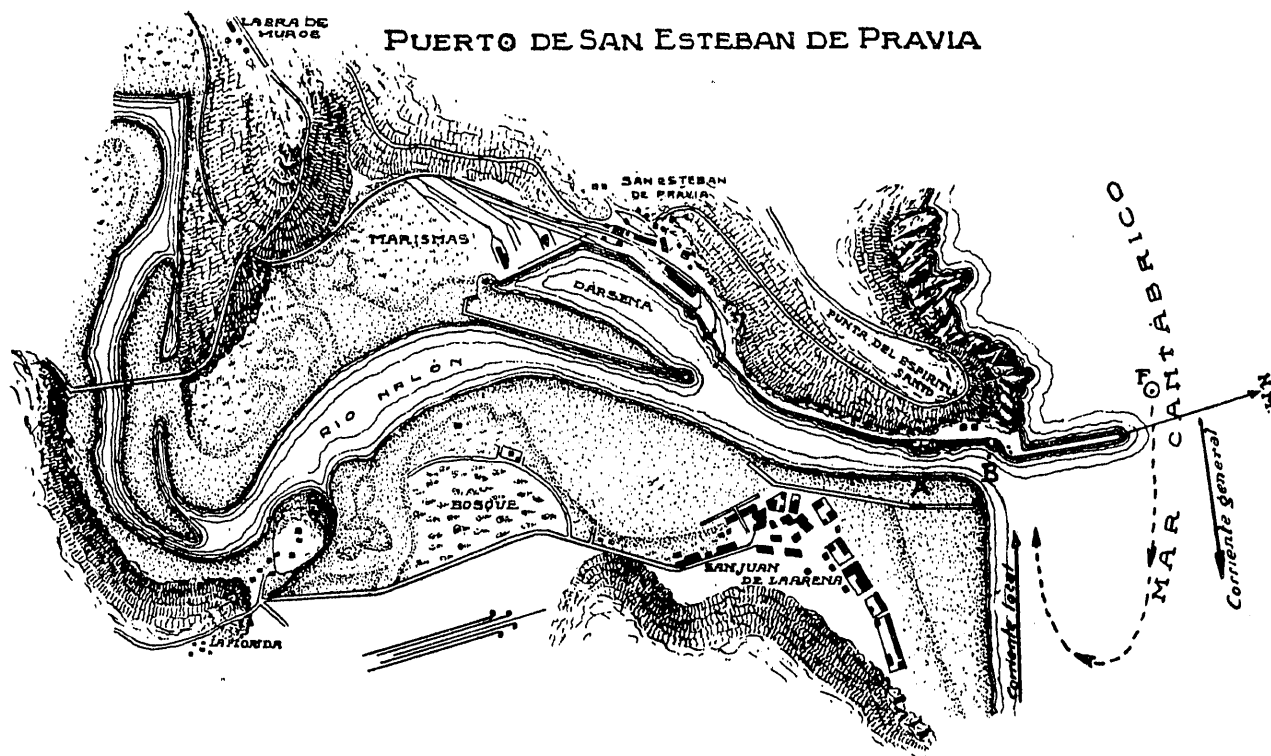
ª Plano general del puerto de San Esteban de Pravia
